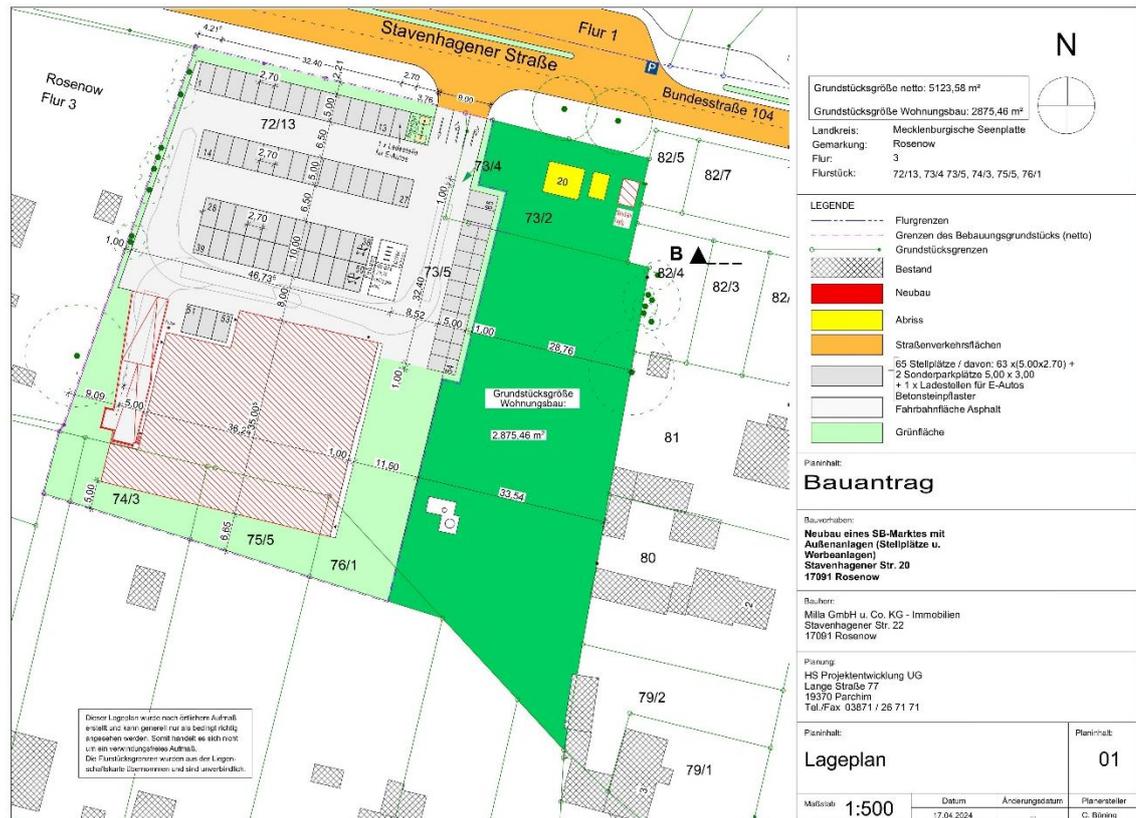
Lageplan zum Bauvorhaben der Errichtung eines SB-Marktes mit Nebenanlagen
